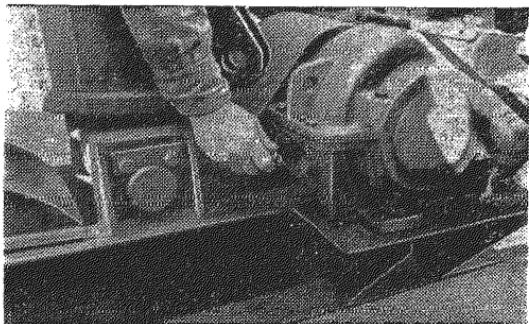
Проверка уровня масла масломерной линейкой в корпусе редуктора механизма передвижения башенного крана МСК-5/20
